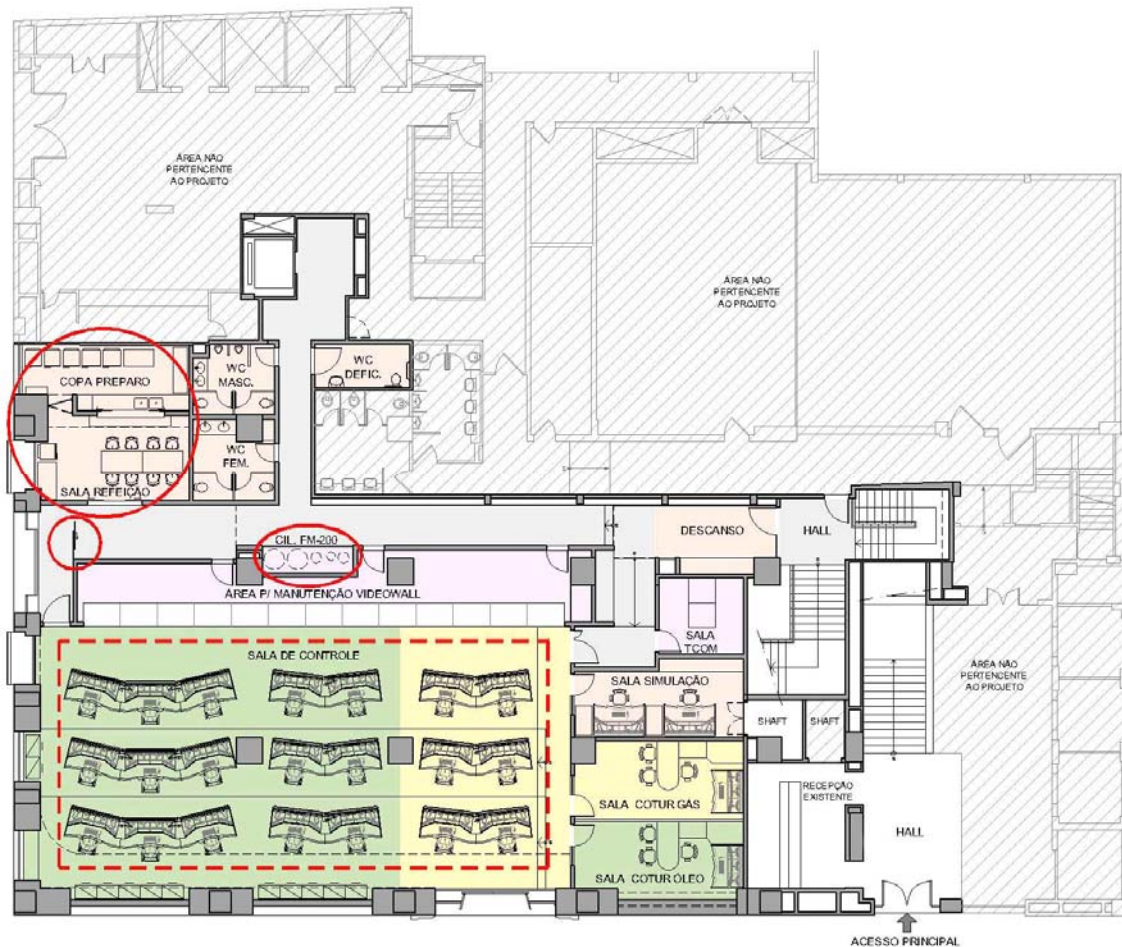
Planta baixa pavimento térreo: layout apresentado na revisão do *milestone* 3
